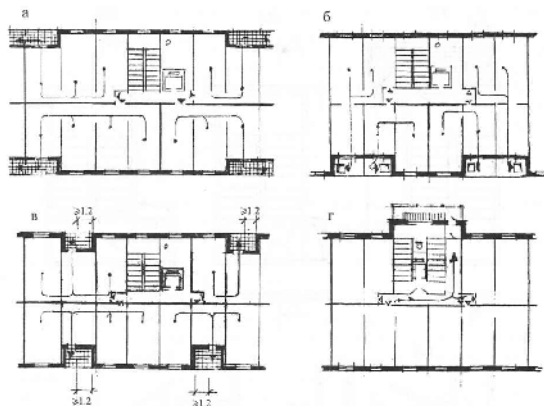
Дополнительные противопожарные меры безопасности в домах высотой 6 этажей и более с эвакуационной лестницей типа Л-1: а – аварийный переход в смежную секцию через лестничное помещение, б – то же по пожарным лестницам между балконами; в – устройство островков безопасности в коридорах, г – то же по наружной лестнице Л-3
